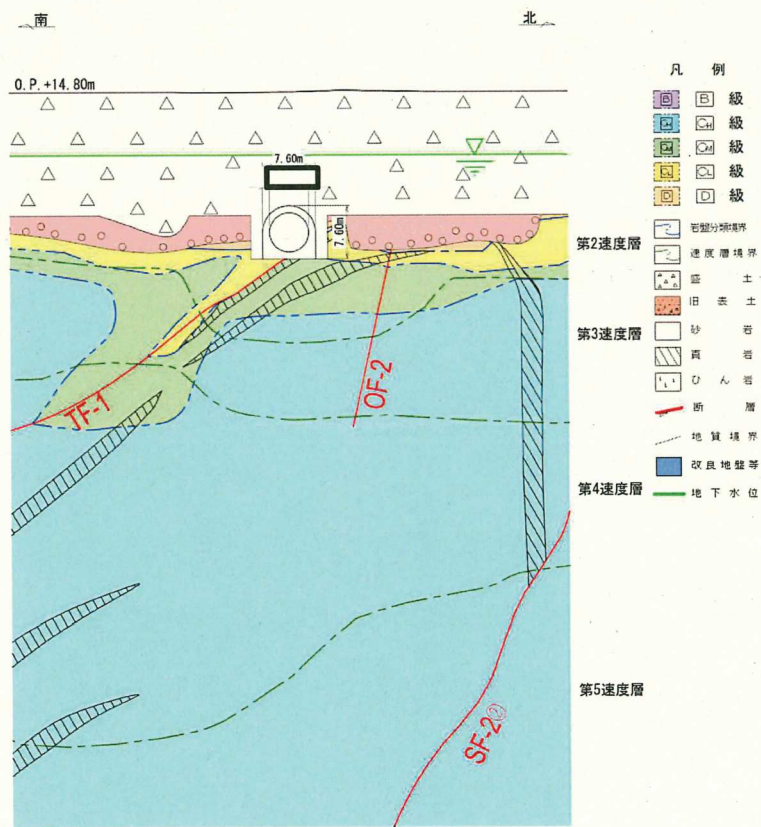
(2) 排気筒連絡ダクト（土砂部） 評価対象断面図（断面②）
